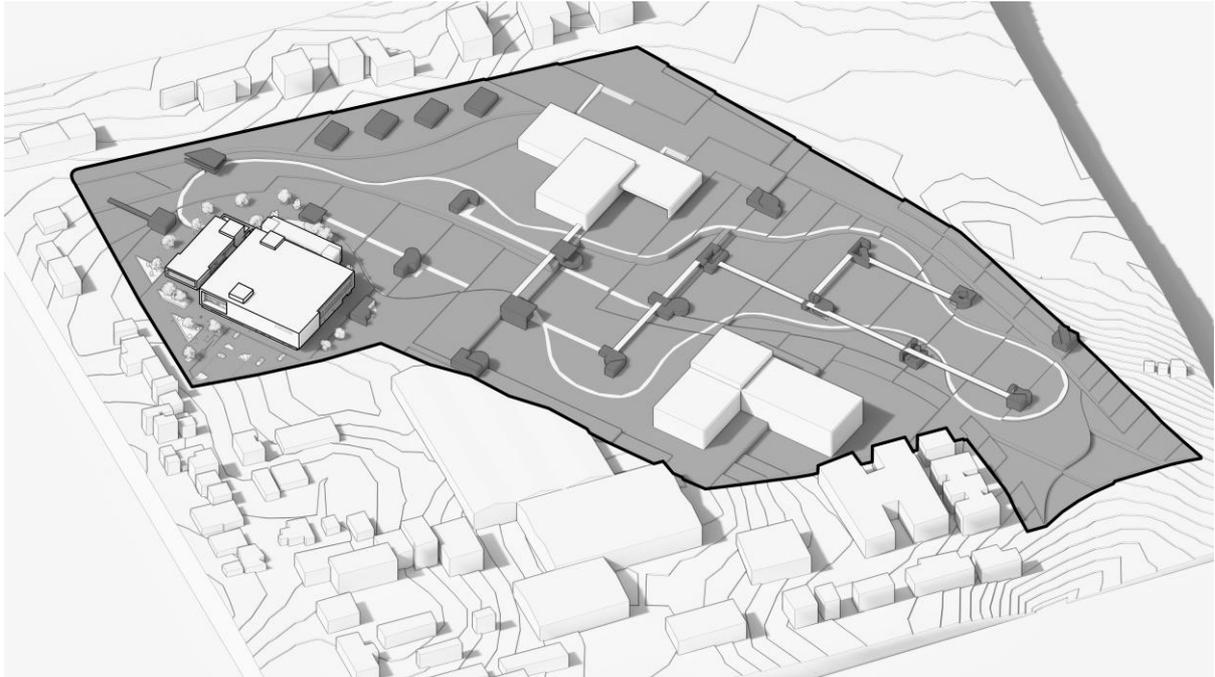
Vista axonométrica plan masa. Elaboración propia.
